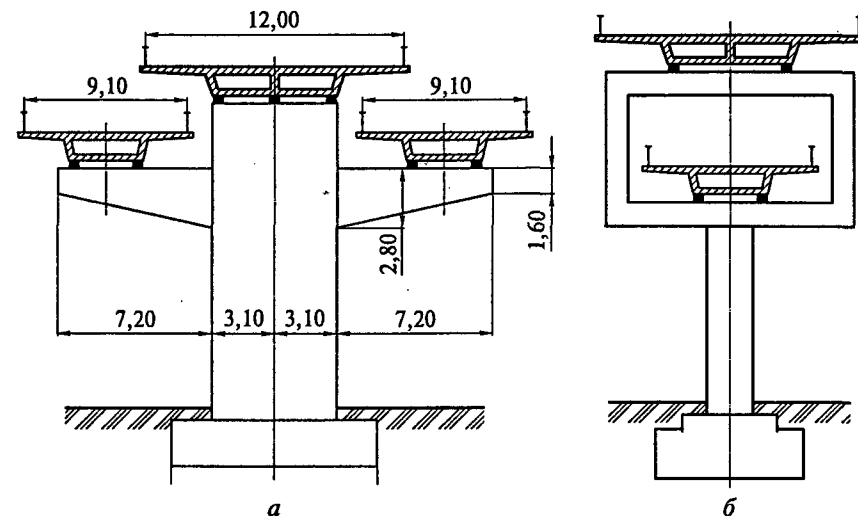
Опоры многоярусных транспортных пересечений:
